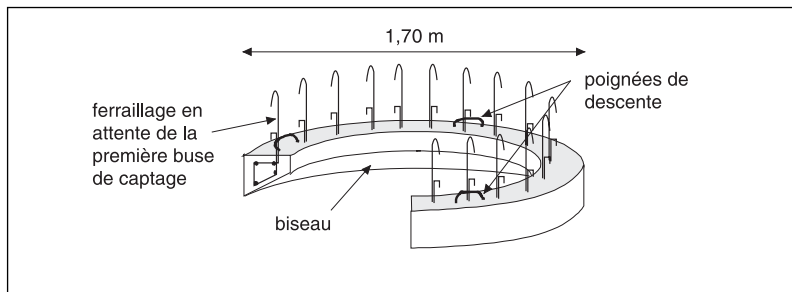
Trousse coupante par buse 1,40/1,60.
